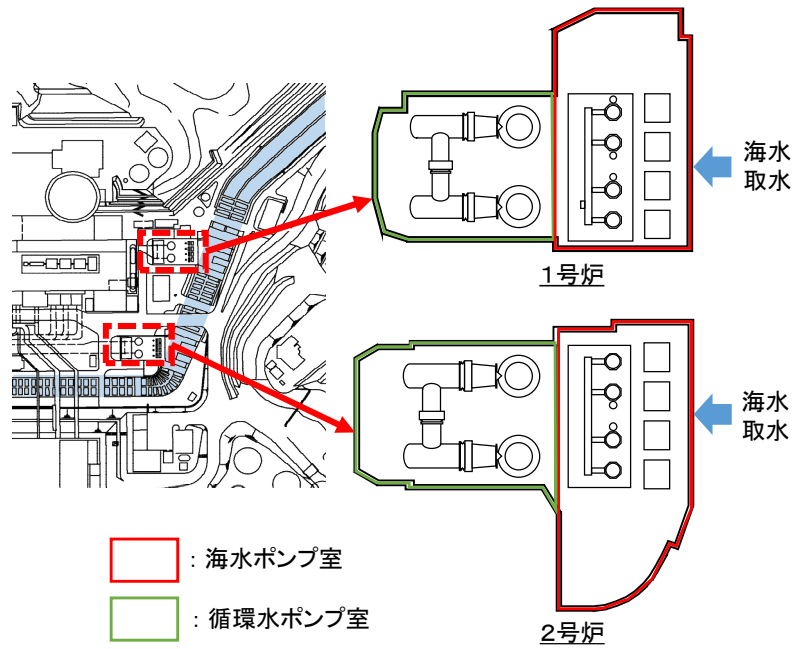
1号及び2号炉海水取水設備（平面図）
